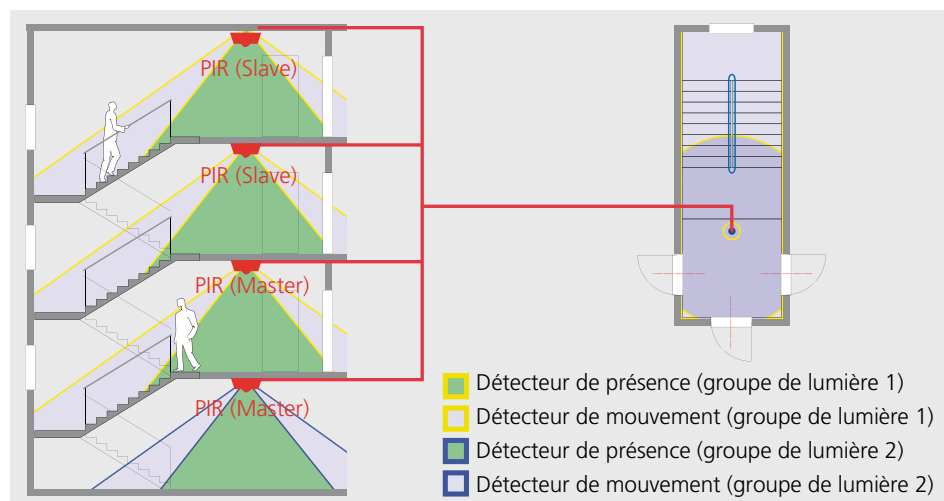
Exemple de planification PIR dans une cage d'escalier. (Source: Swisslux)
